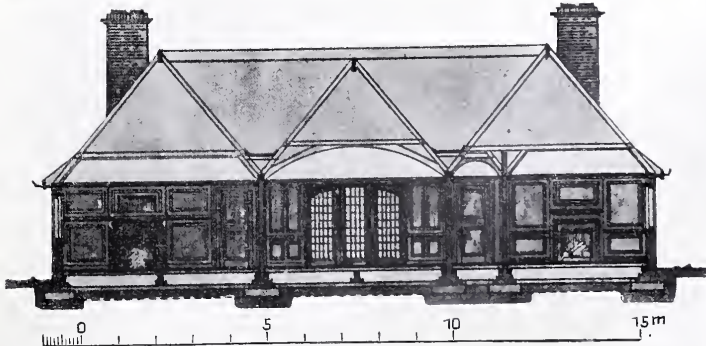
Schnitt durch Eßzimmer, Halle, Schlafzimmer.
